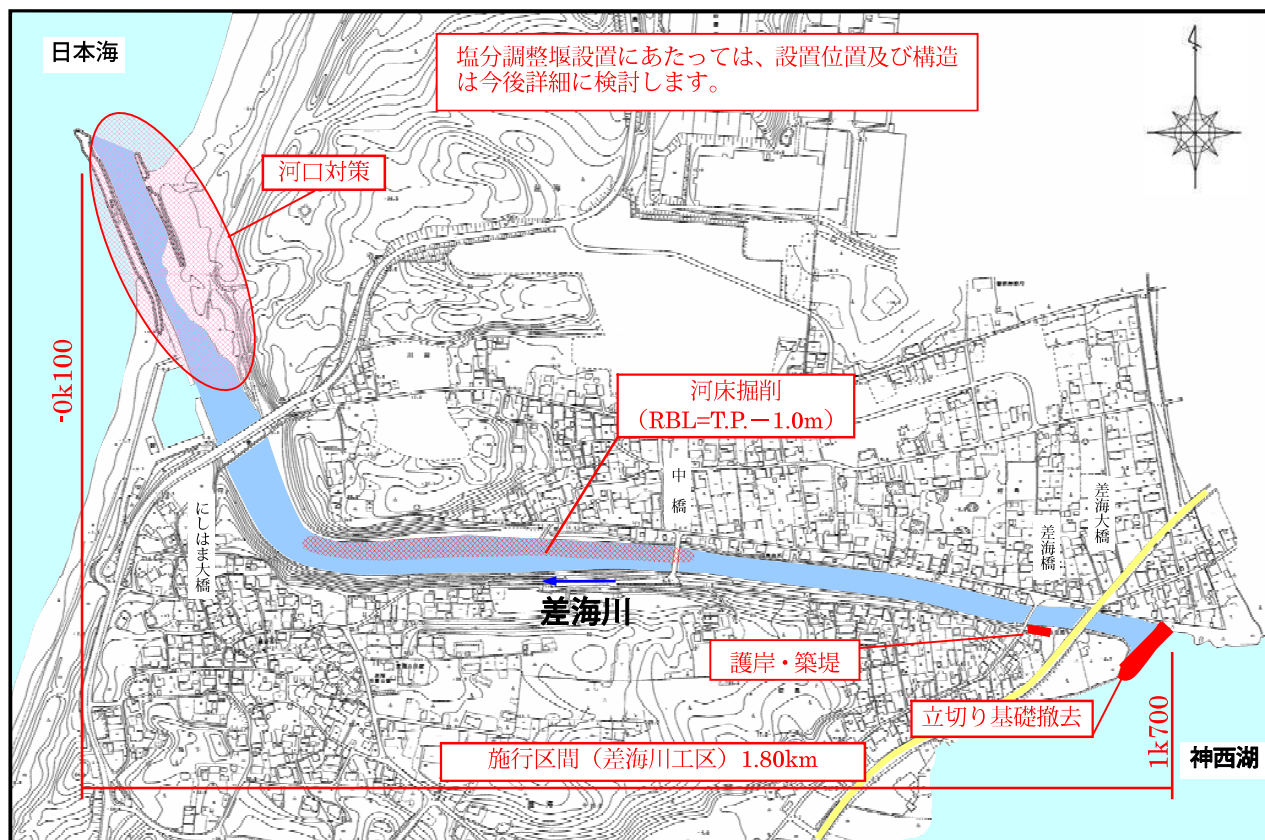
平面図（差海川工区）(S=1/10,000)
